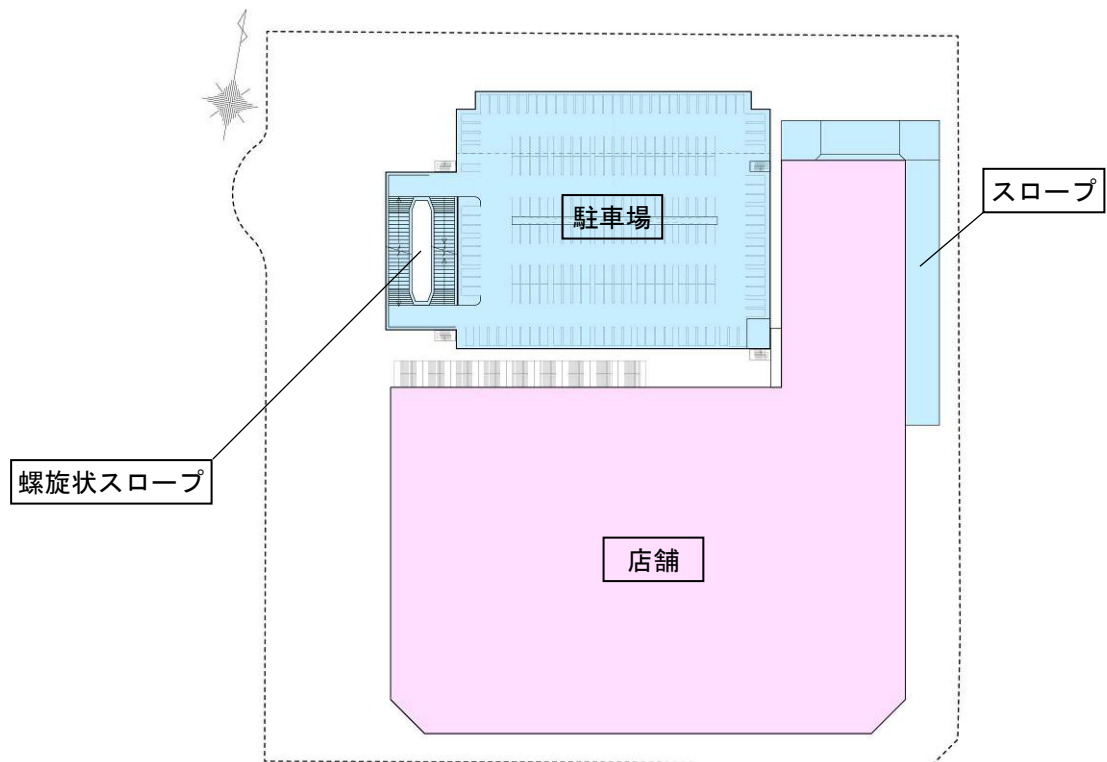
(2) 各階平面図(商業棟 2 階, 駐車場棟 2~4 階)【評価書時】
